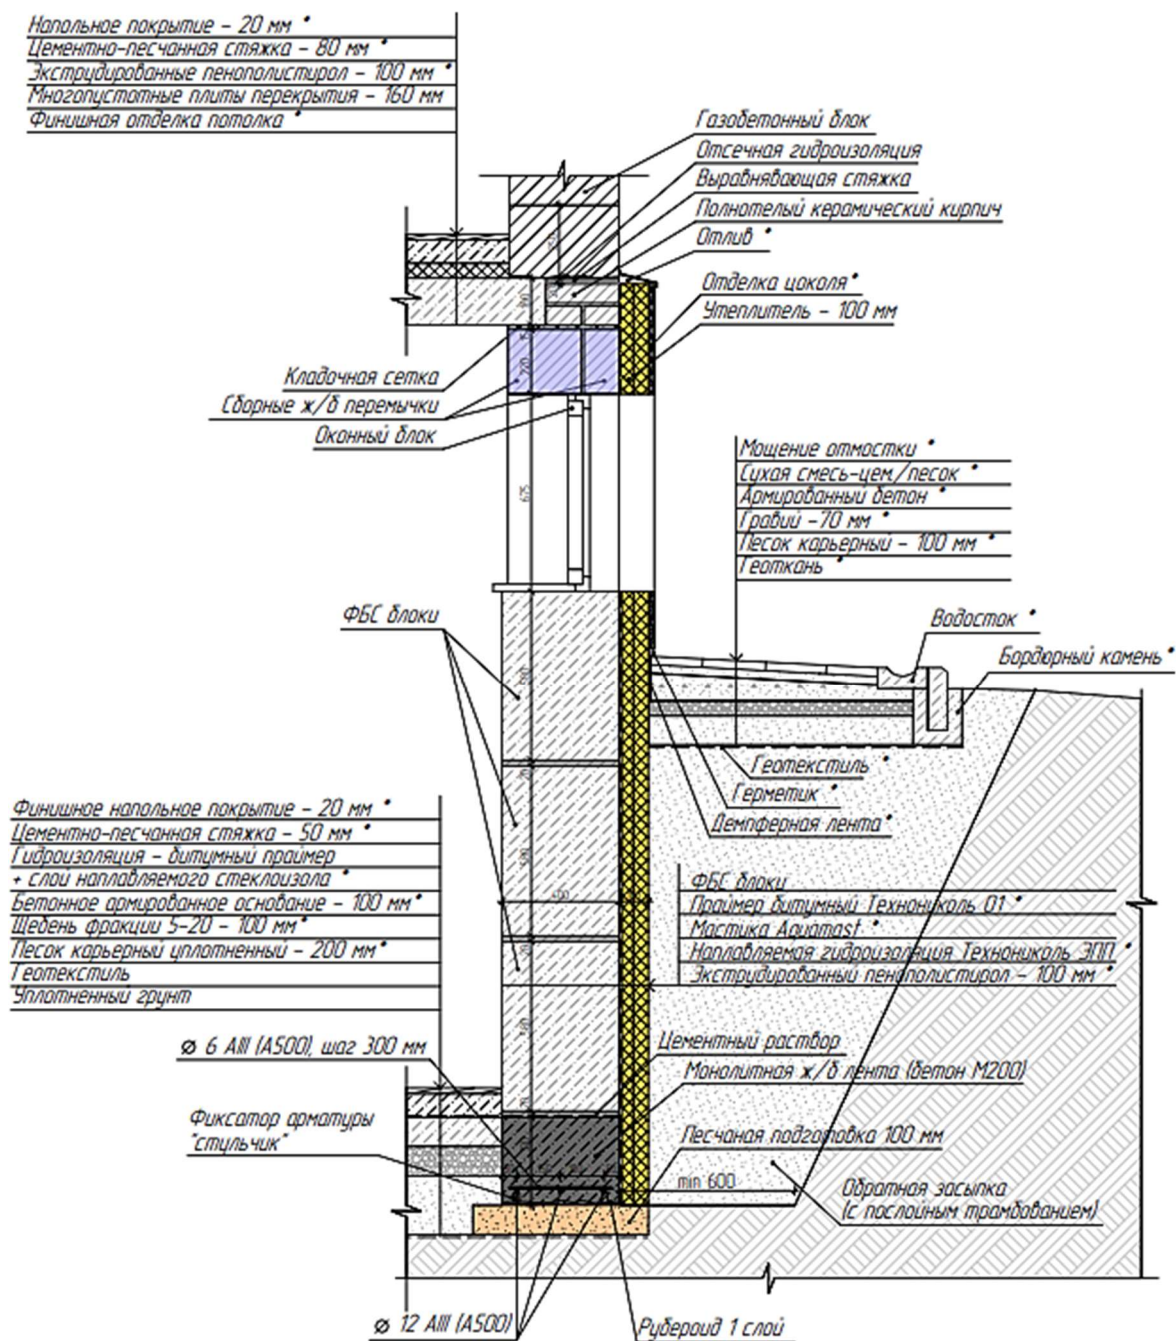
Вариантное решение разреза по стене в здании с подвалом
